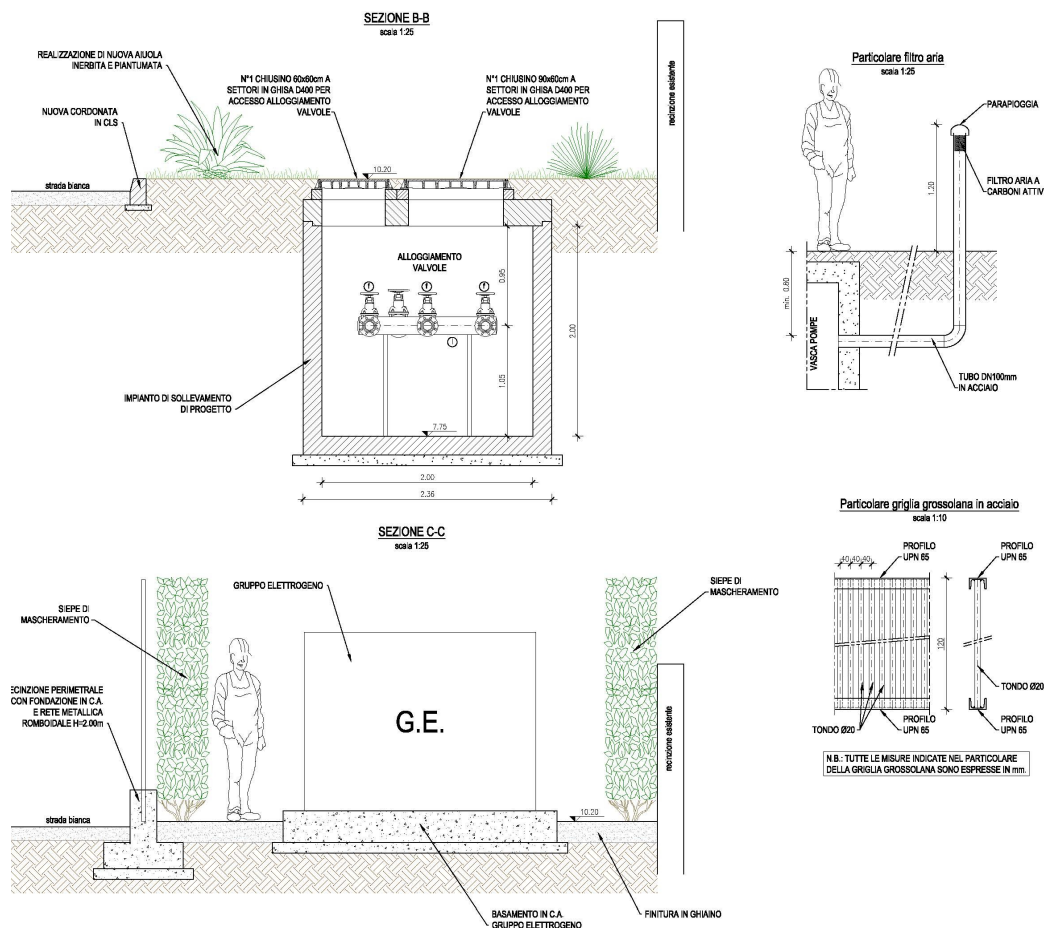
Pianta, sezioni e particolari dell'impianto S6.
